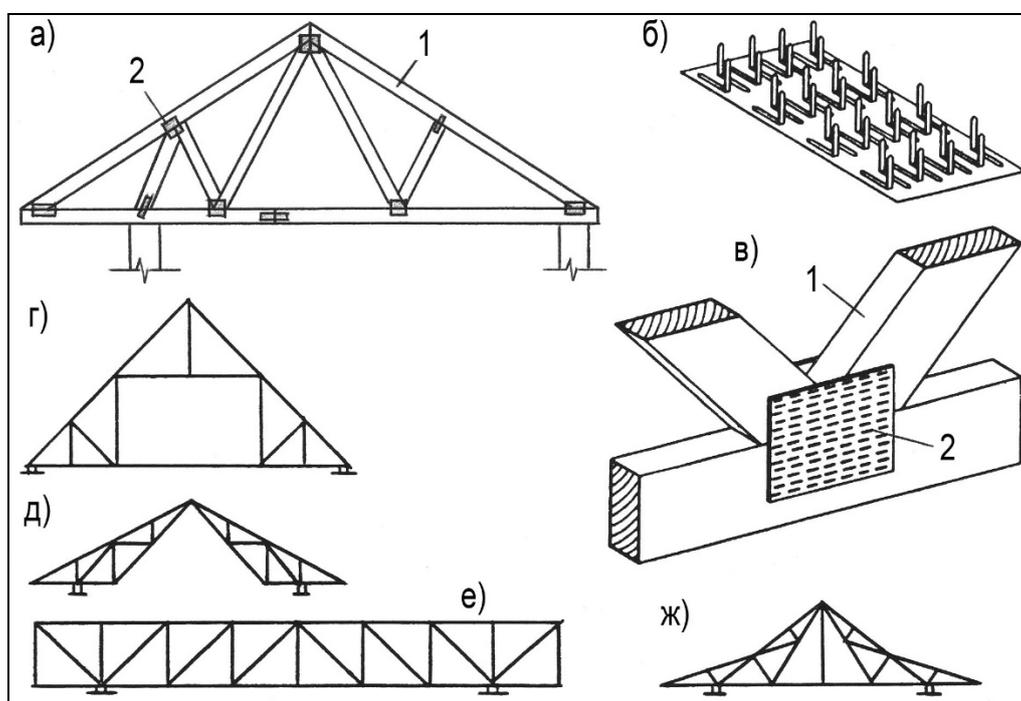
Система деревянных ферм «Гэнг-Нейл»; а – треугольная ферма с консольным выпуском, б – металлический коннектор, в – сопряжение элементов фермы (узел фермы), г–ж – примеры форм деревянных ферм, изготовленных способом «Гэнг-Нейл»; 1 – элемент фермы (подкос), 2 – металлический коннектор
